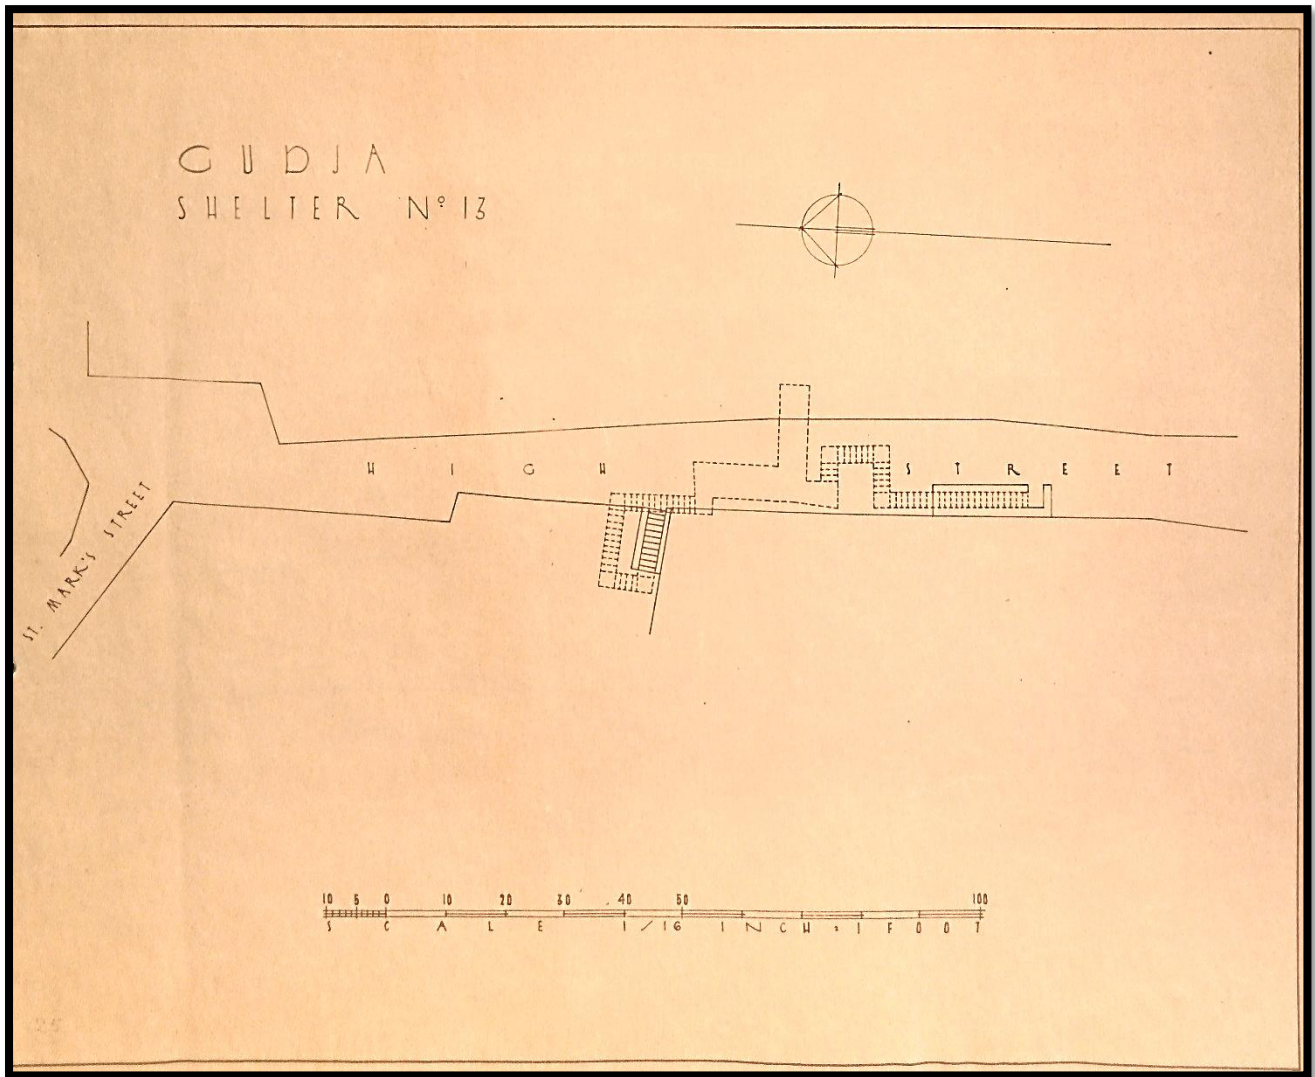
Planta do Abrigo nº13 "St. Mark's Street – High Street."
